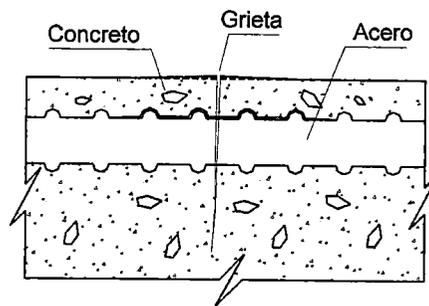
Grieta en sentido transversal al acero.
